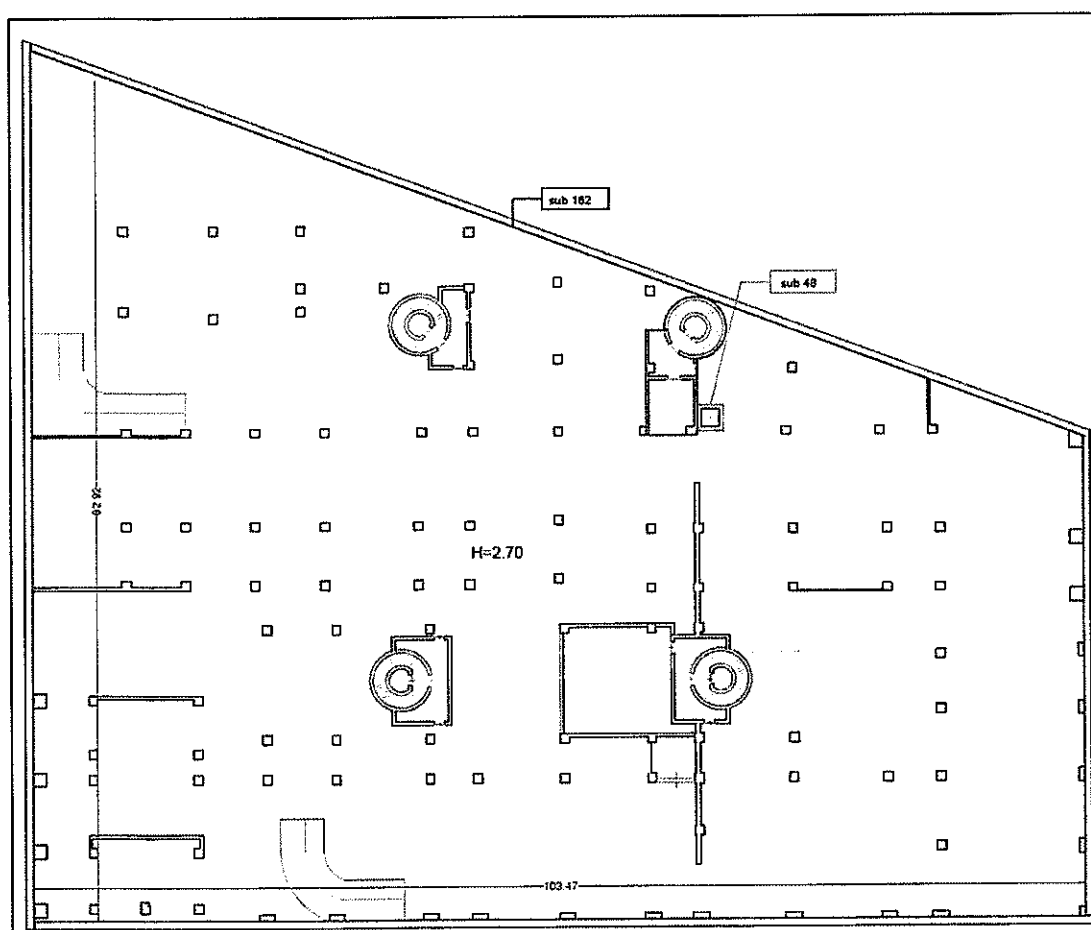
Rilievo planimetrico del piano secondo interrato (in grigio le porzioni comuni e/o di proprietà aliena).
